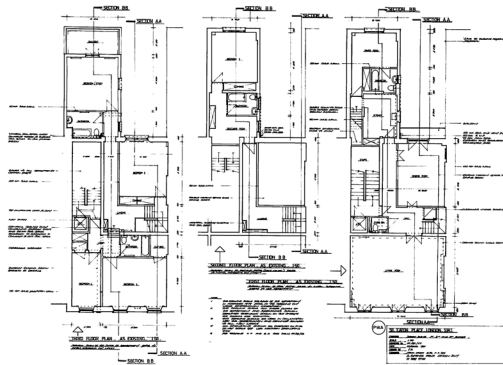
Plantas de la vivienda 59 Eaton Place en su estado anterior al proyecto realizado por Zaha Hadid.
